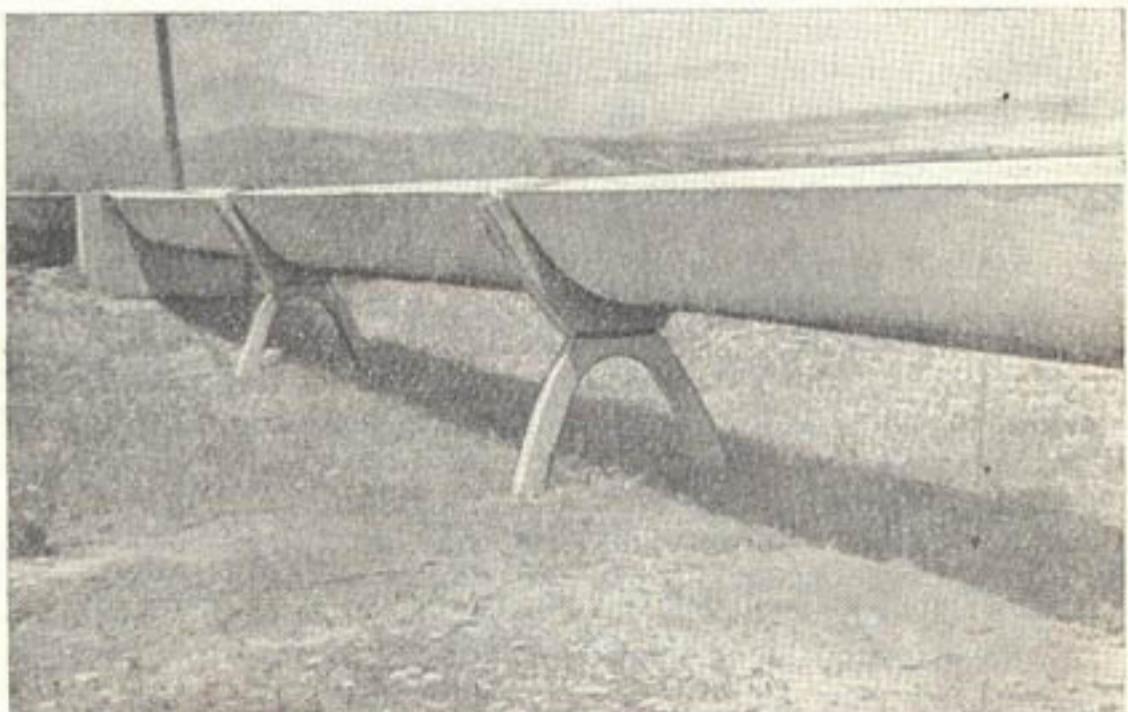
Лотковый канал из предварительно напряженных железобетонных звеньев (Грузинская ССР).
